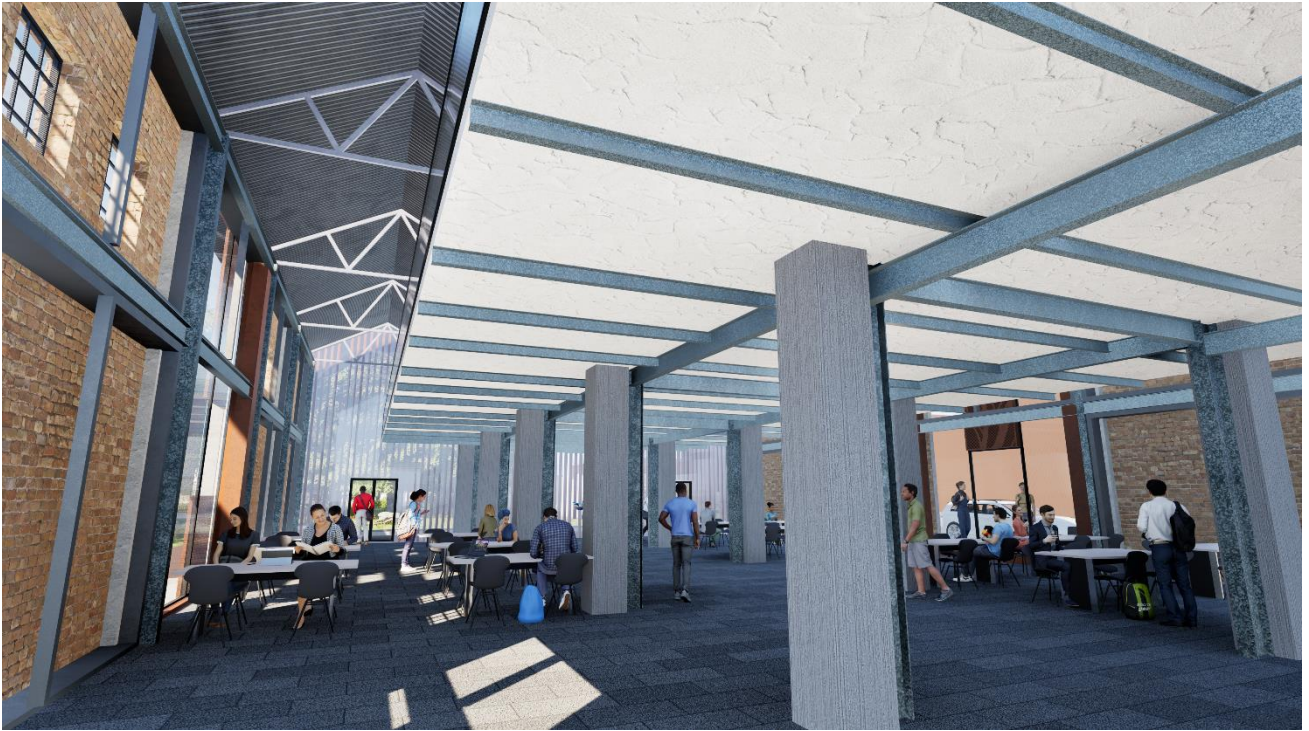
Vista interna edificio deposito corto, piano terreno.
